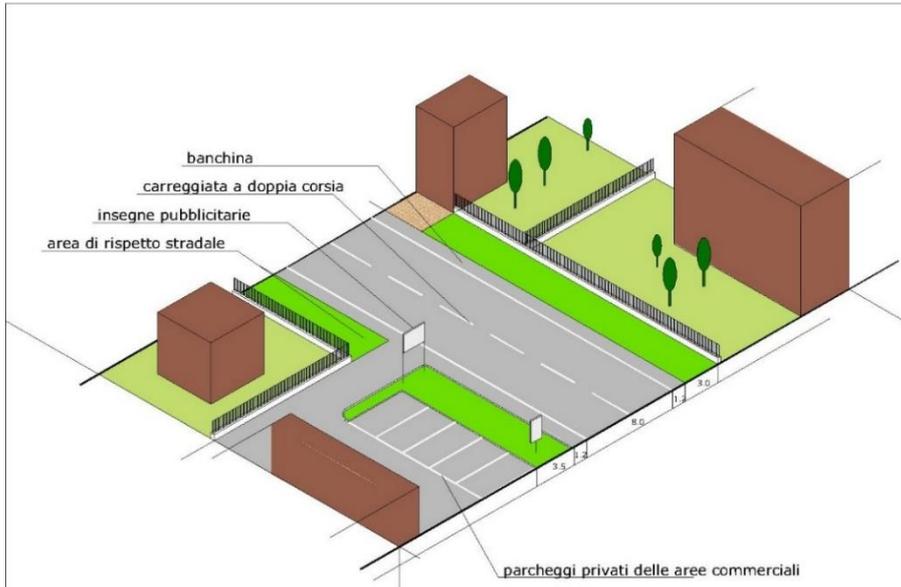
Rappresentazione schematica stato di fatto sezione 4
